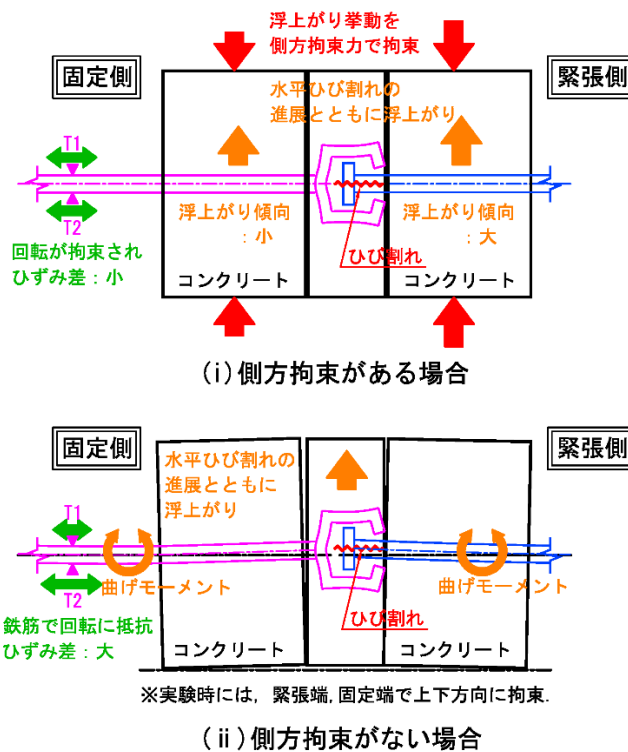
水平ひび割れの進展に伴う浮上がり
